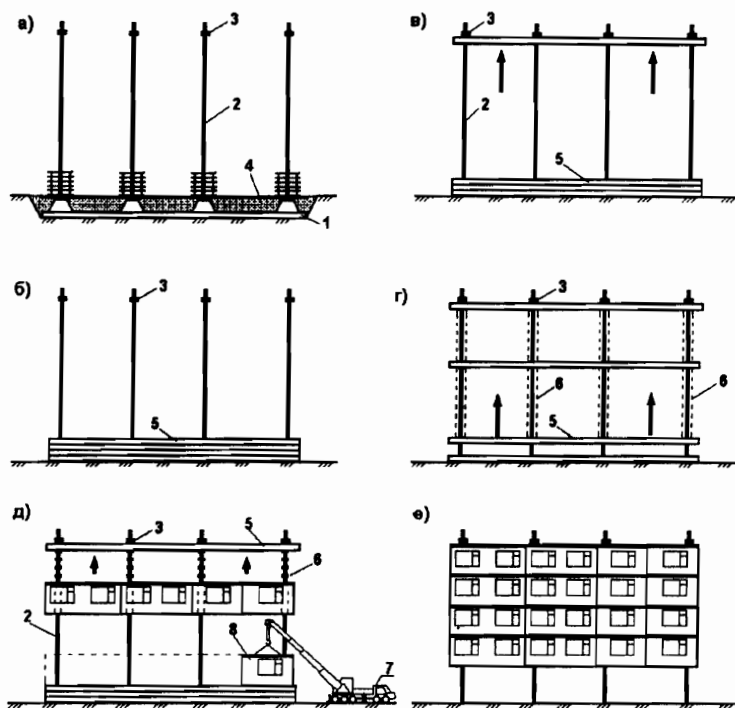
Принципиальные технологические схемы возведения зданий методом подъема перекрытий (а...г) и методом подъема этажей (д,е): 1 - фундаментная плита; 2 - направляющие (колонны); 3 - домкраты; 4 - засыпка основания; 5 - пакет монолитных плит перекрытия; 6 - грузовые тяги; 7 - монтажный кран; 8 - панель стены
